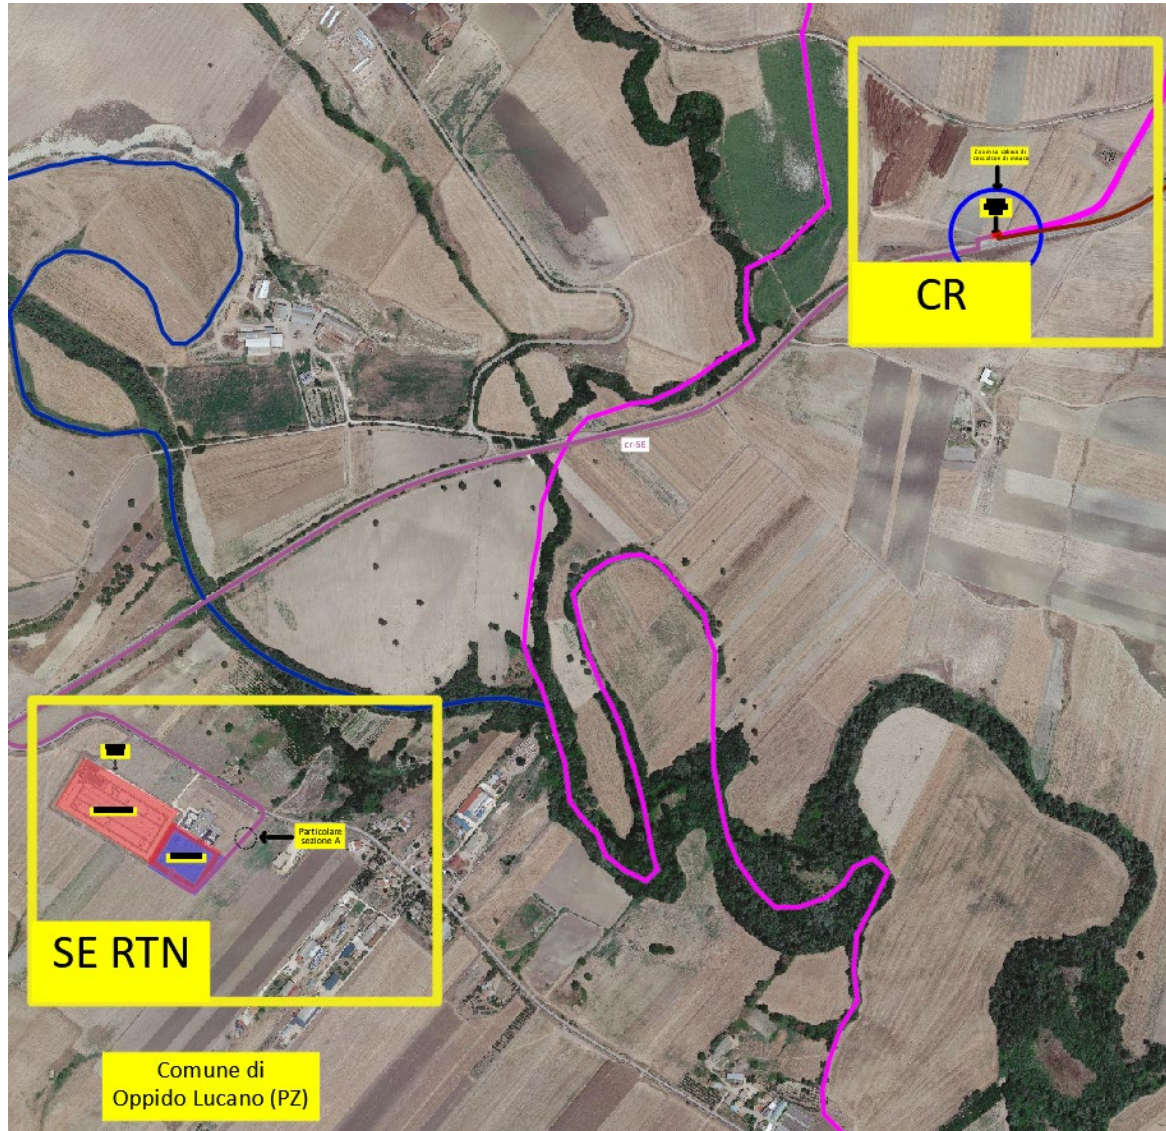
Collegamento CR con SE RTN “Oppido”.
